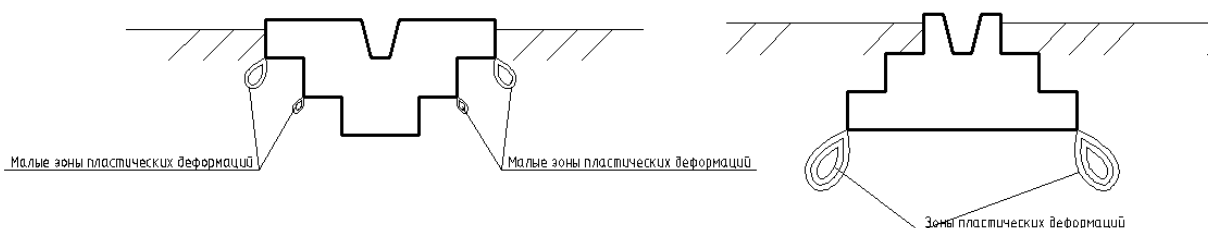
Развитие зон местной потери устойчивости грунта под фундаментами с разным типом подошвы.
